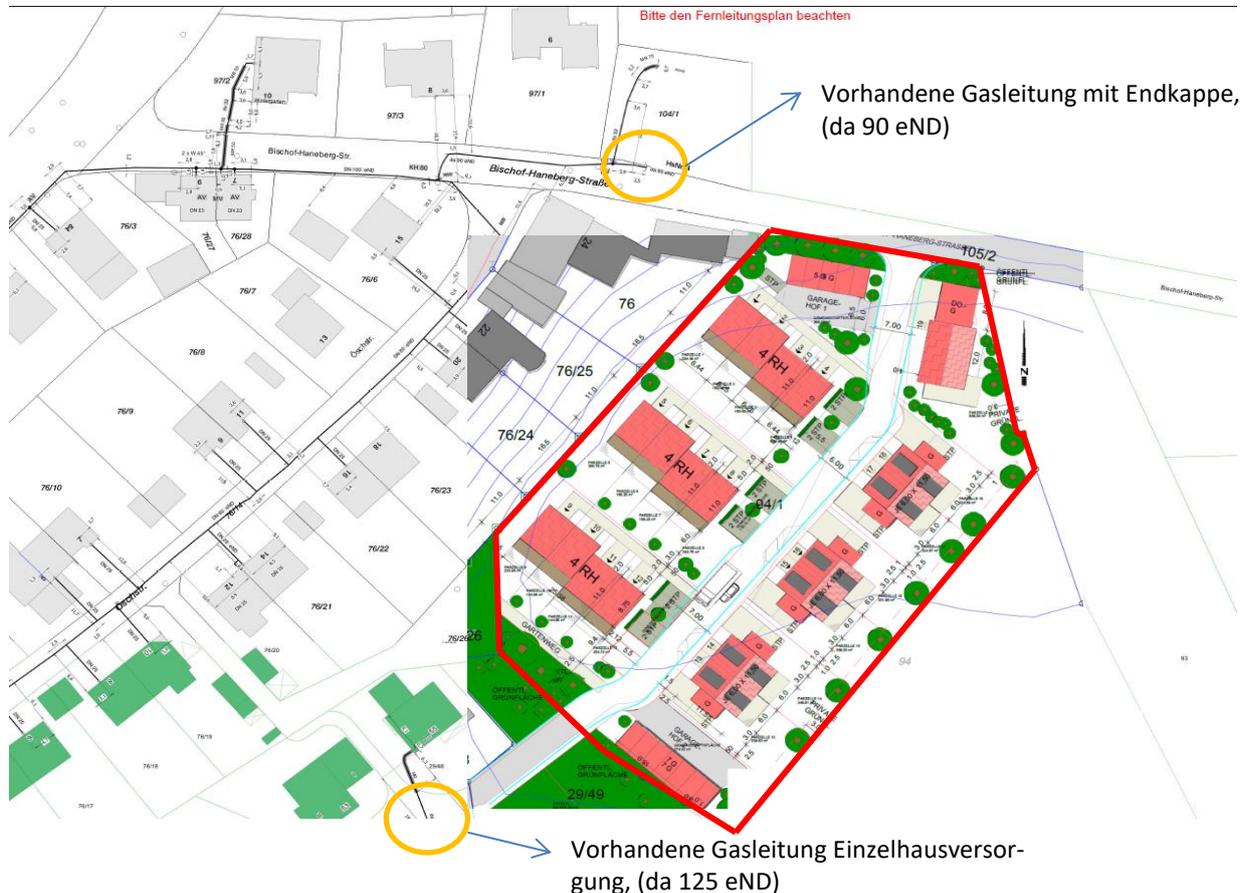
Spartenplan Erdgasanschluss Baugebiet
